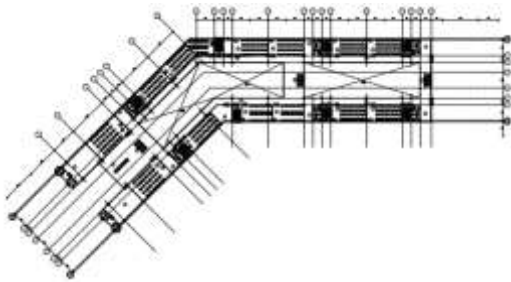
Denah lantai 6 Sekolah Tinggi Parwisata Semarang
